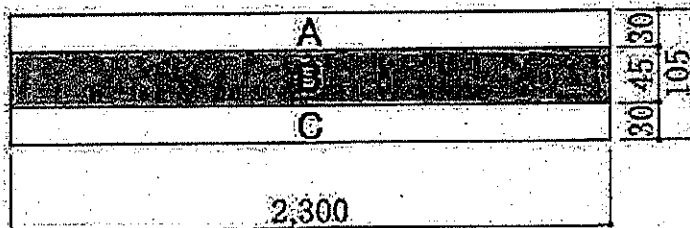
含水率測定位置 (平面図: 外層はヒキ、内層はスキ)
